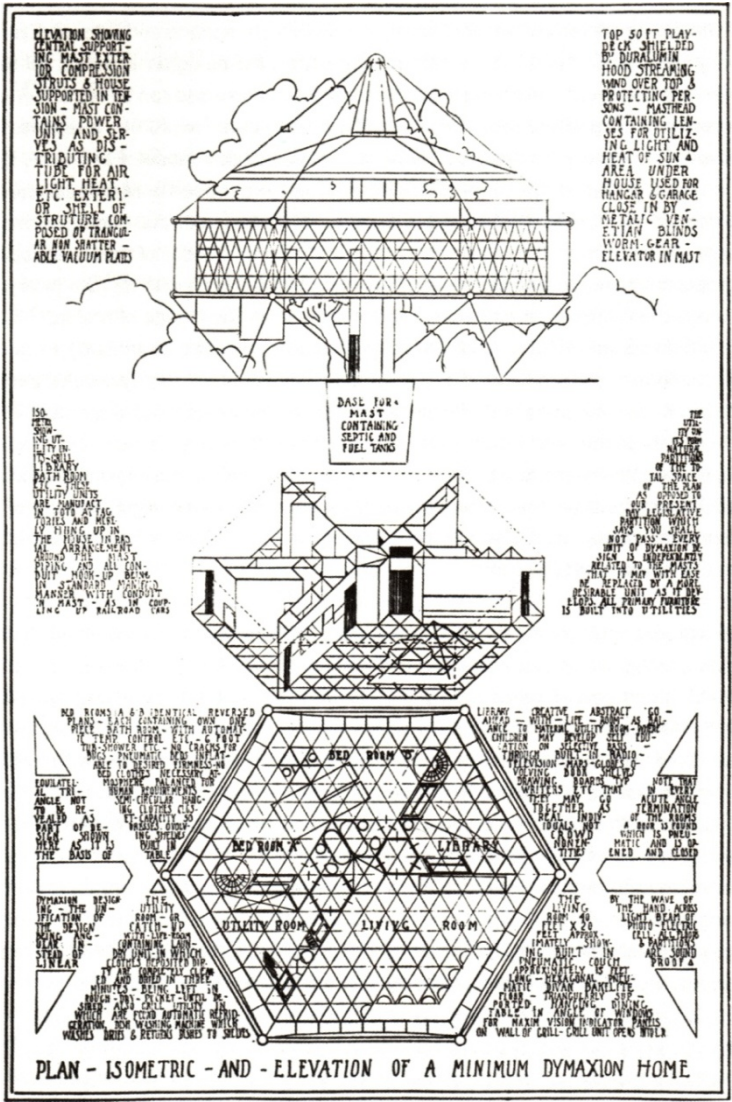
Alçado, Perspectiva e Planta da Dymaxion House.
